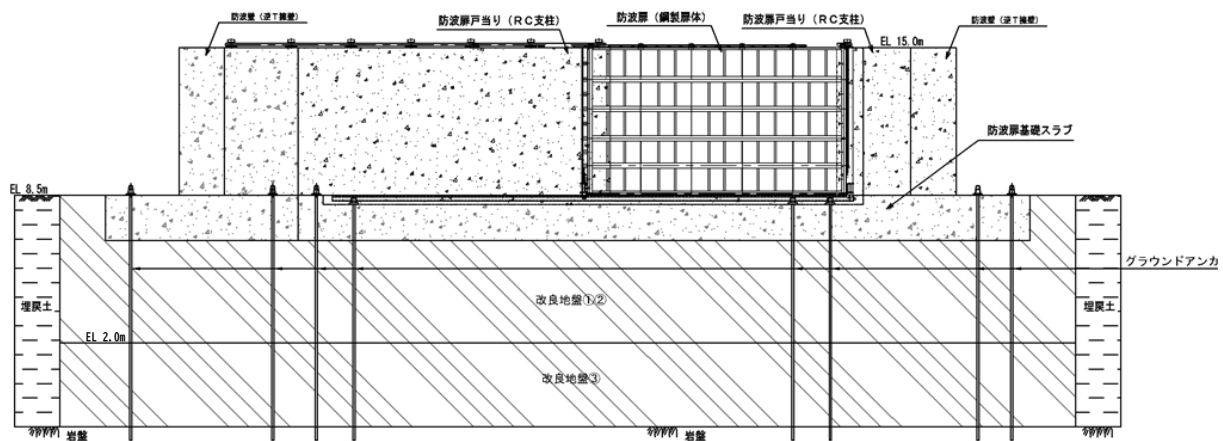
(2) 防波扉の構造図 (鋼製扉体平面図, B-B 断面)
